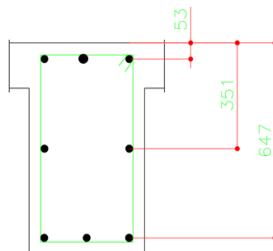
2 Penulangan Tumpuan Balok Induk
